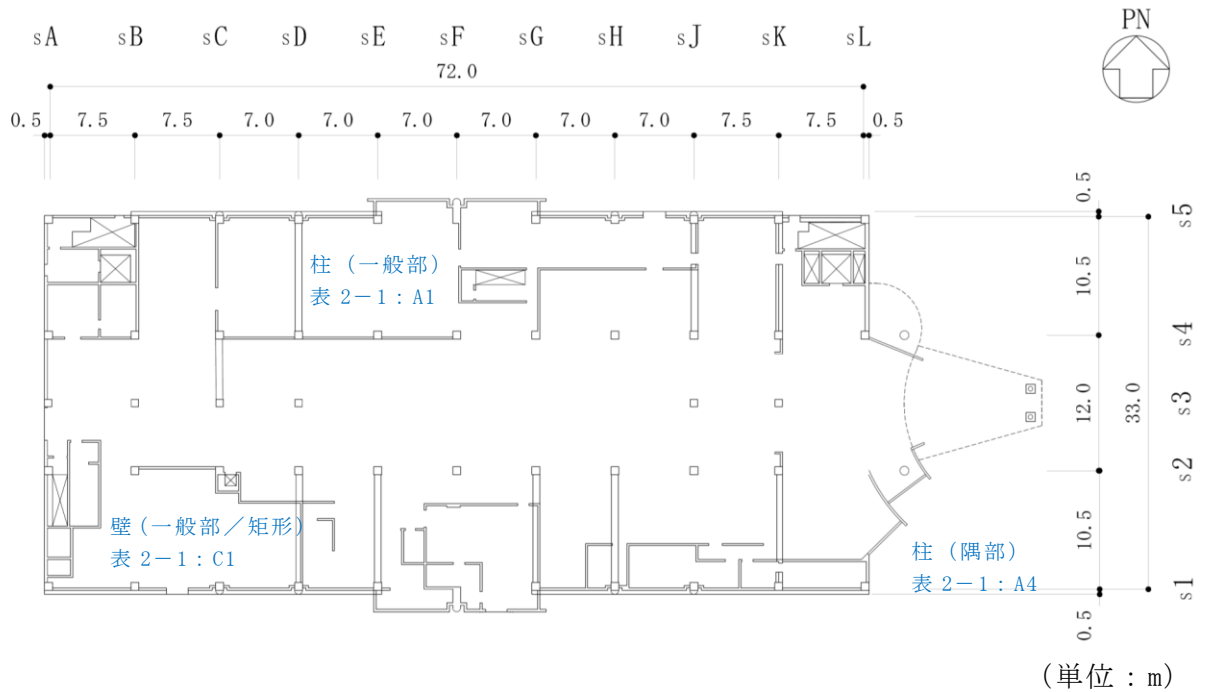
サービス建屋の概略平面図 (1F, T. M. S. L. 12.3m) (2/4)
